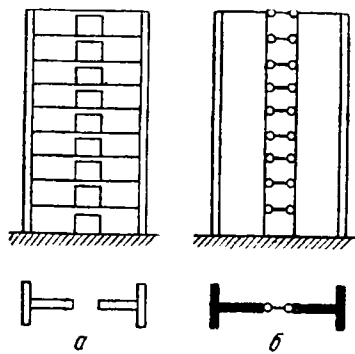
Плоска консольна розрахункова схема панельних будівель:
